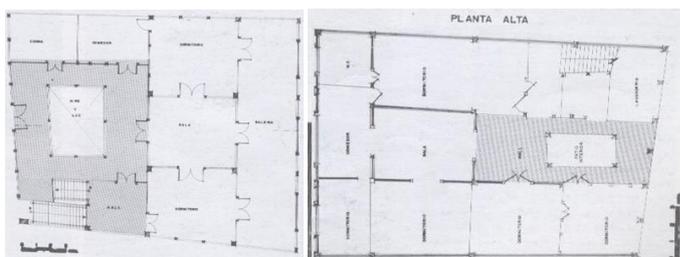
Planta esquemática de la edificación: baja y alta. [3]
